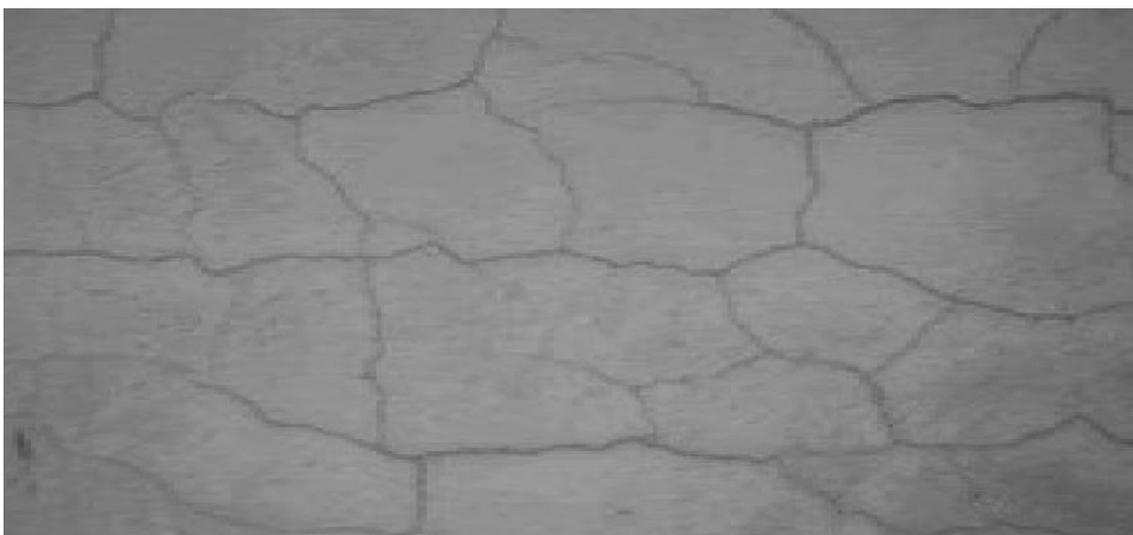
Revestimento apresentado fissuração em mapa, típica em argamassa de alta retração (CARASEK, 2007).
